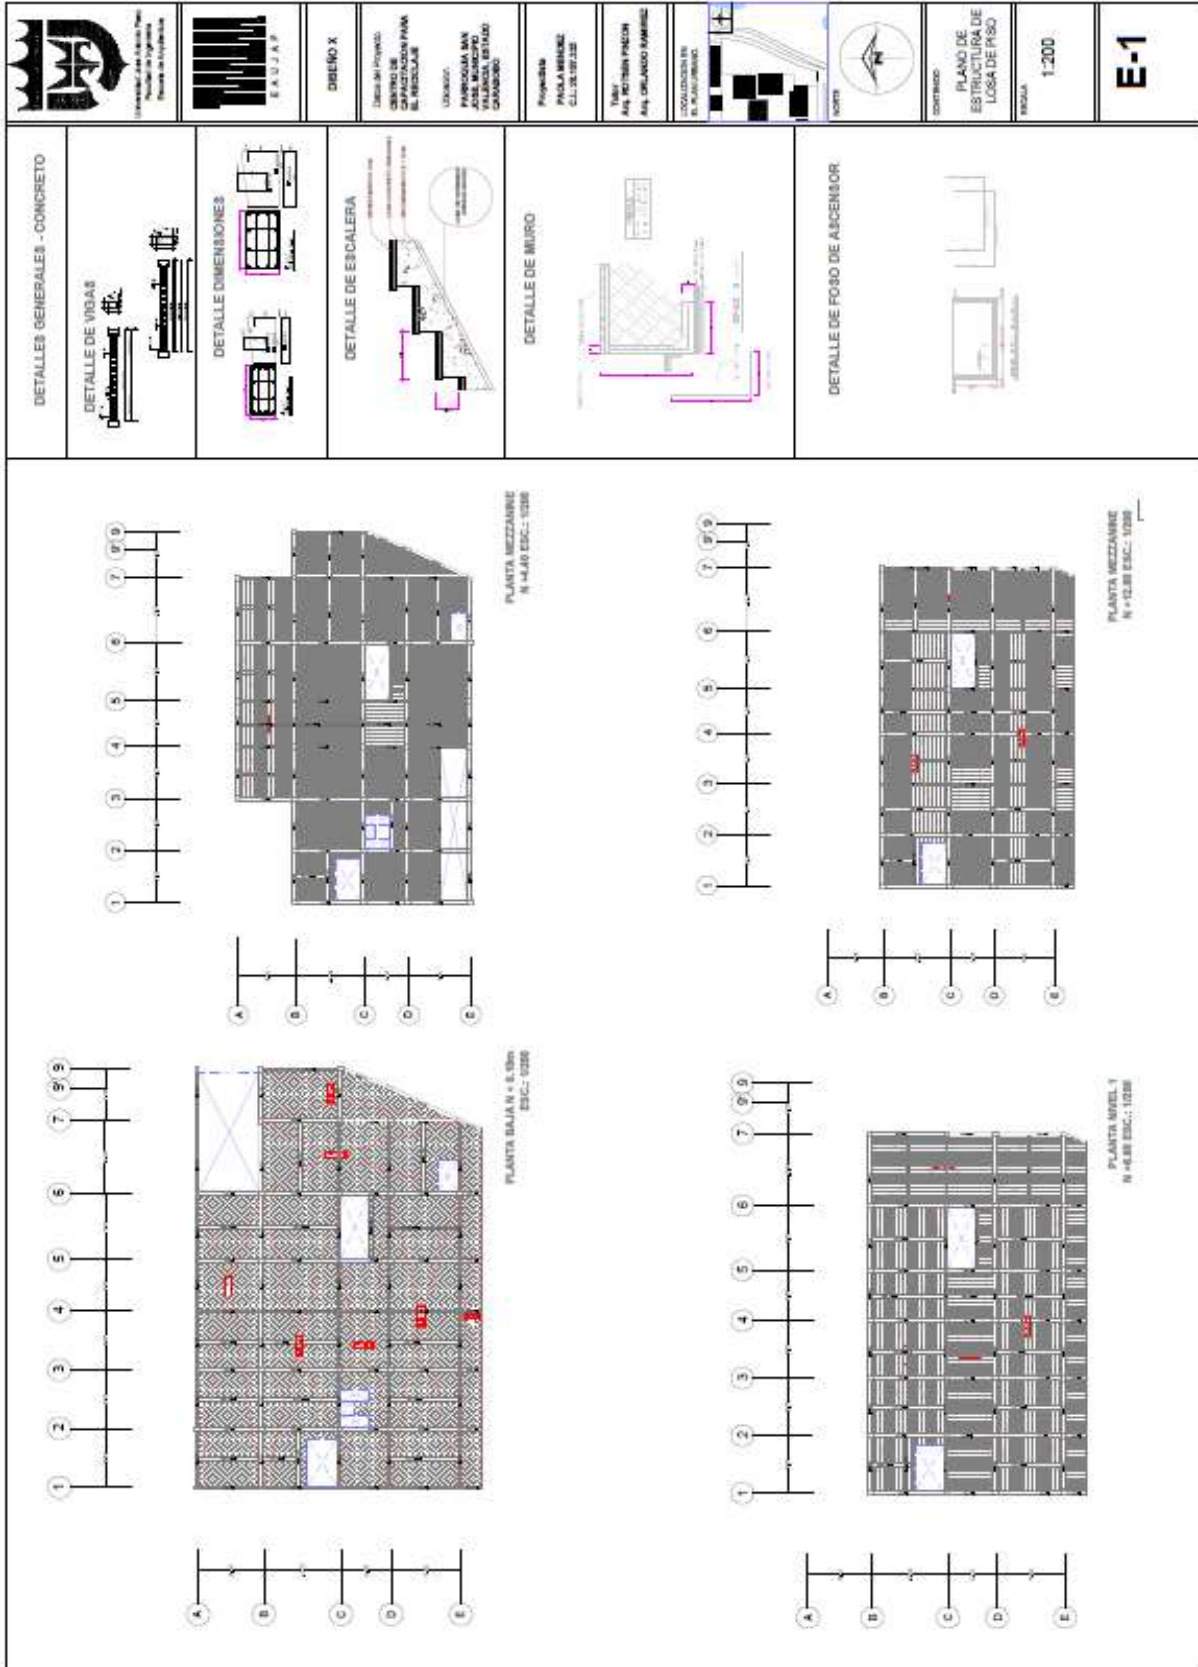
E-1 Plano de Estructura de Losa de Piso Fuente: La Autora (2023)
